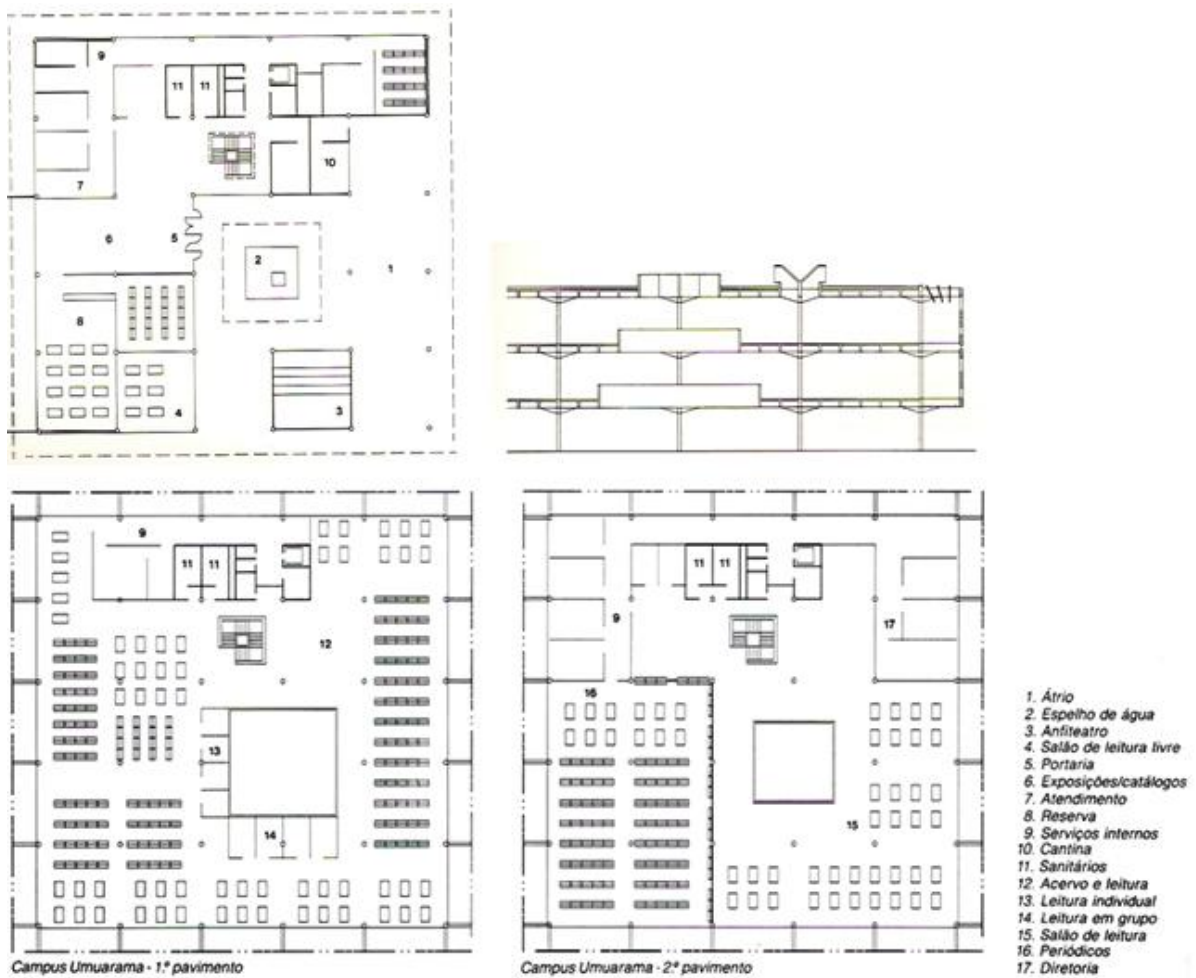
Plantas e cote dos 3 pavimentos do campus Umuarama
